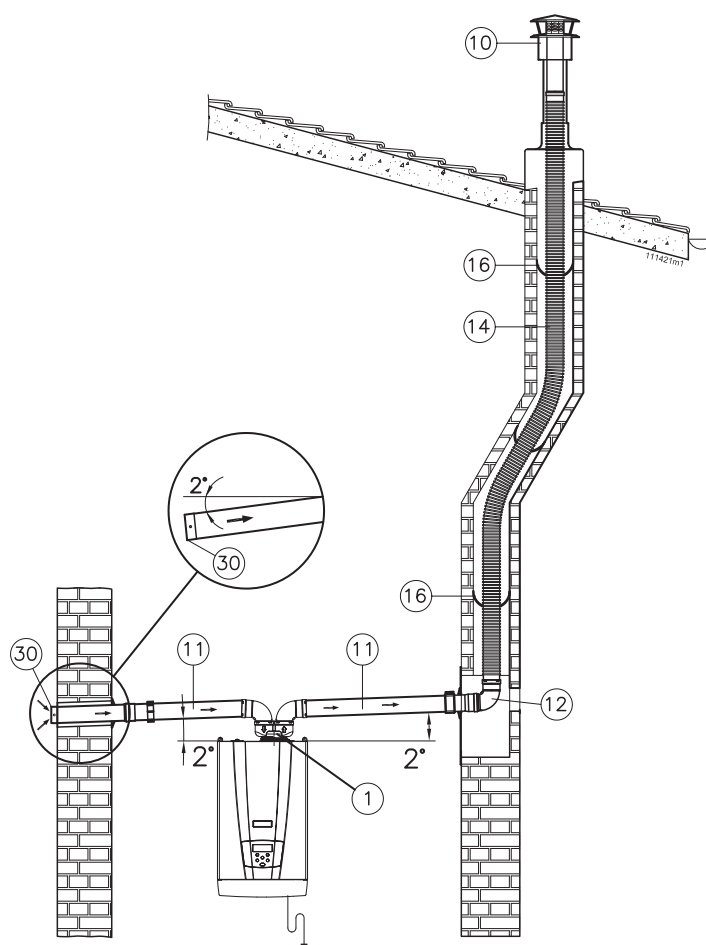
Esempio di installazione "Sistema 80/80 PP"
